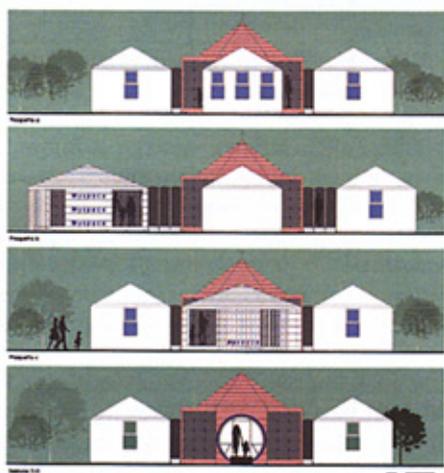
Progetto Myspace, prospetti e sezioni (tratto dalla Tesi di V. Castiglione)
